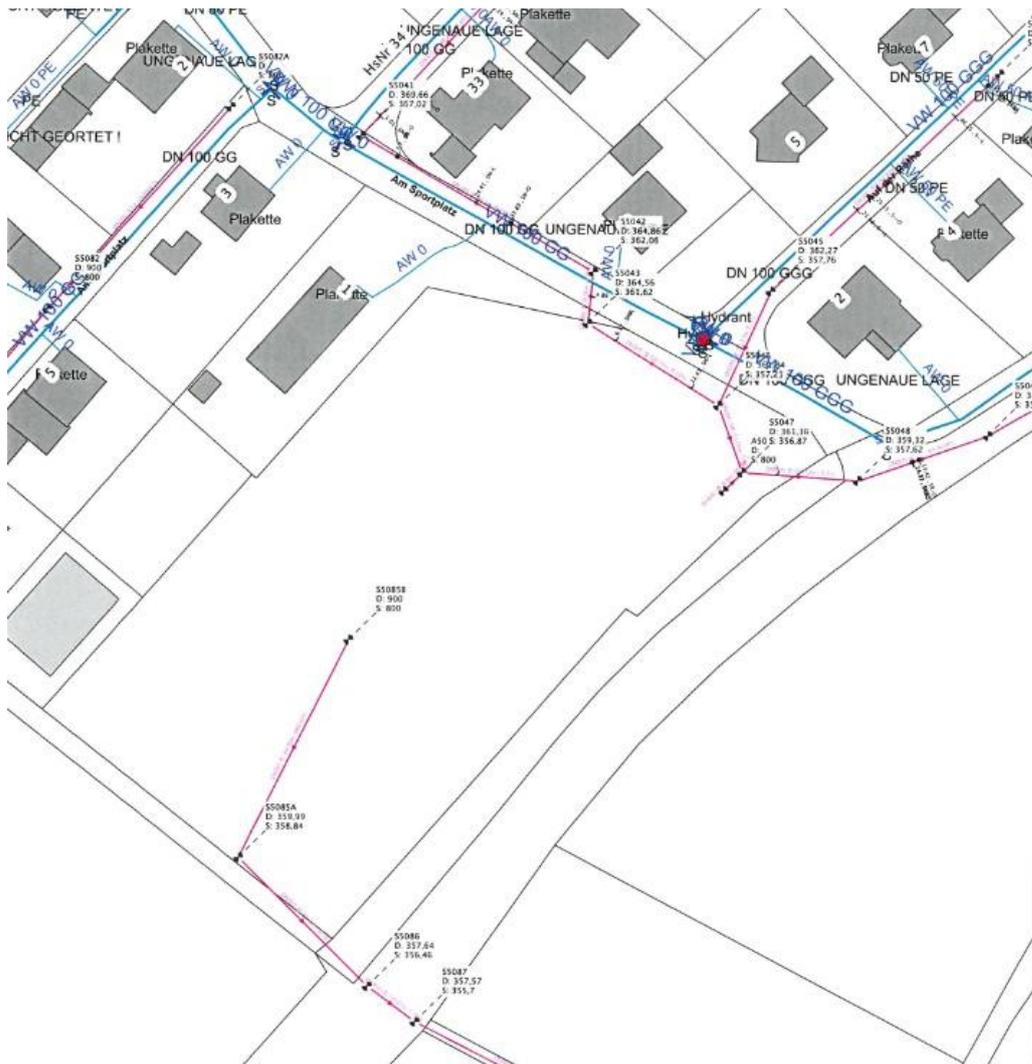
Bestehende Leitungen: Kanal (rote Darstellung), Wasser (blaue Darstellung)
